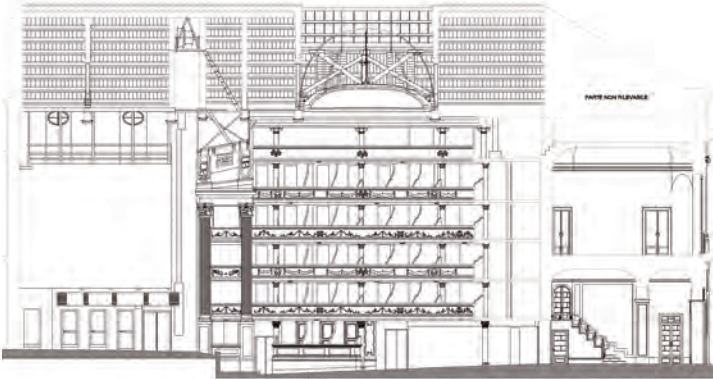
Restituzione del rilievo longimetrico della sezione longitudinale del teatro
